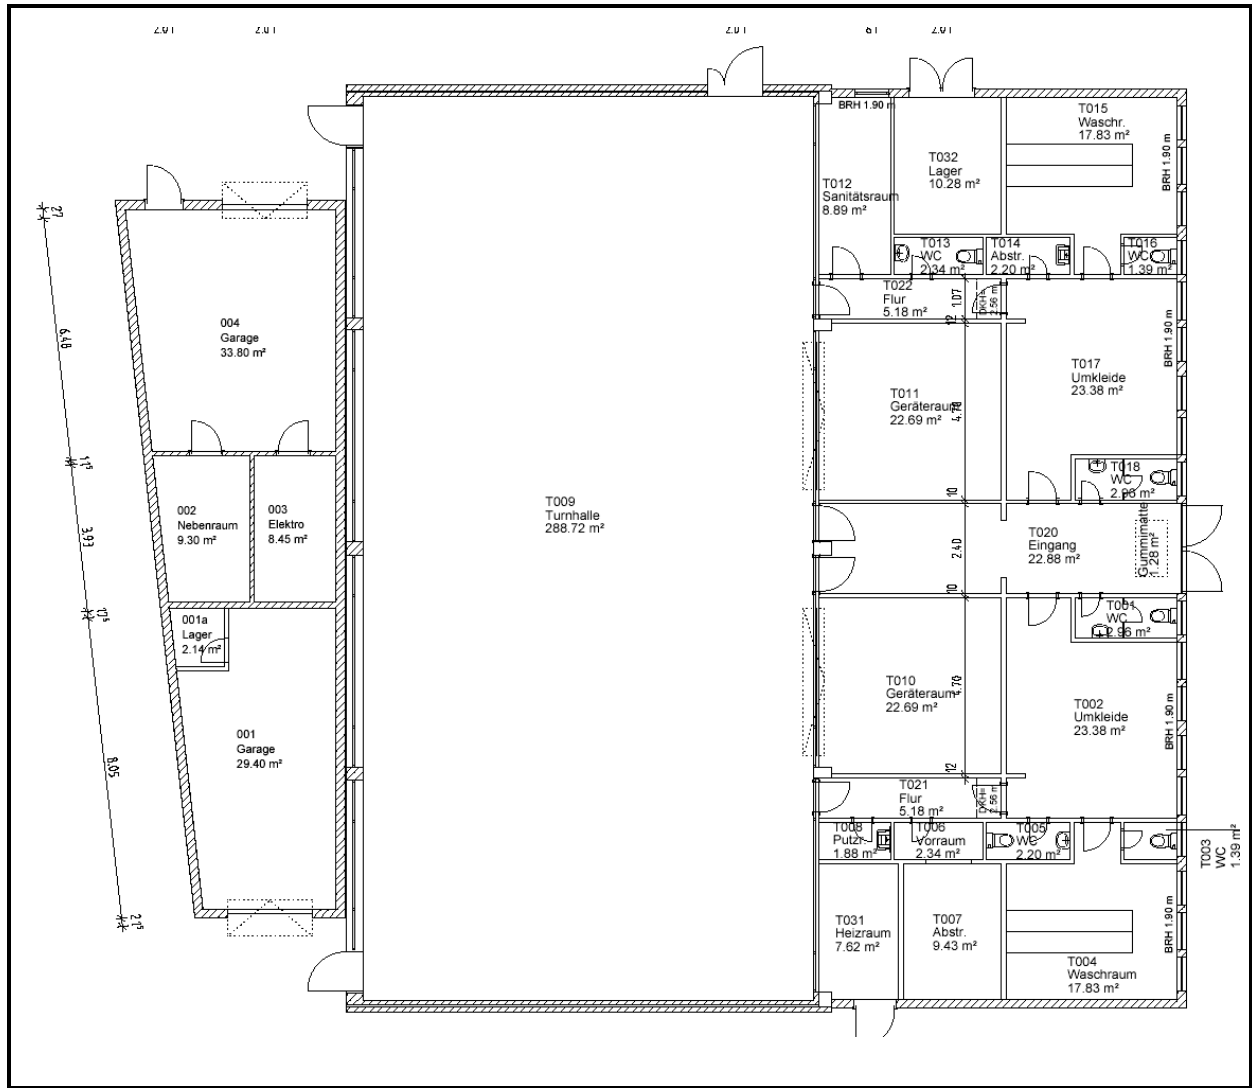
Wendelinusschule: Grundriss Erdgeschoss Turnhalle
